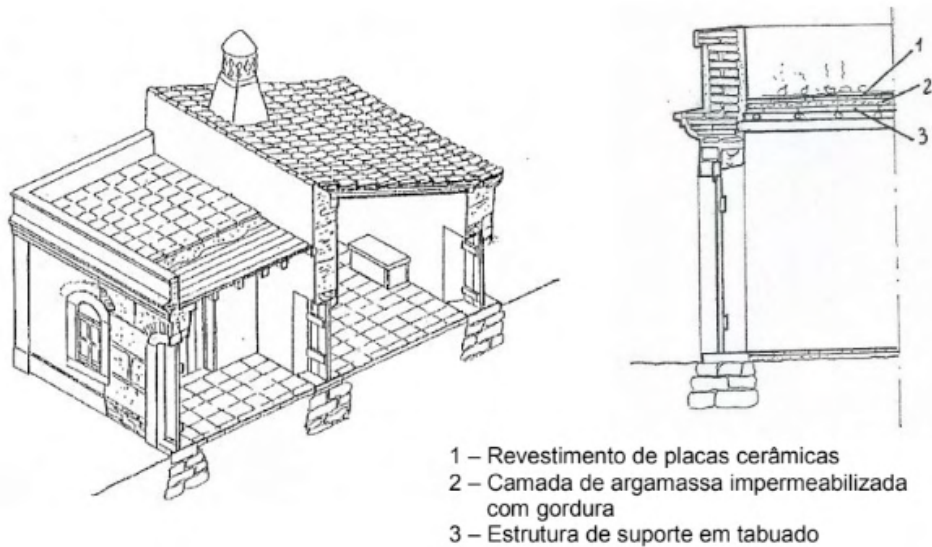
Casa do Algarve: Corte em perspetiva e corte em pormenor.
